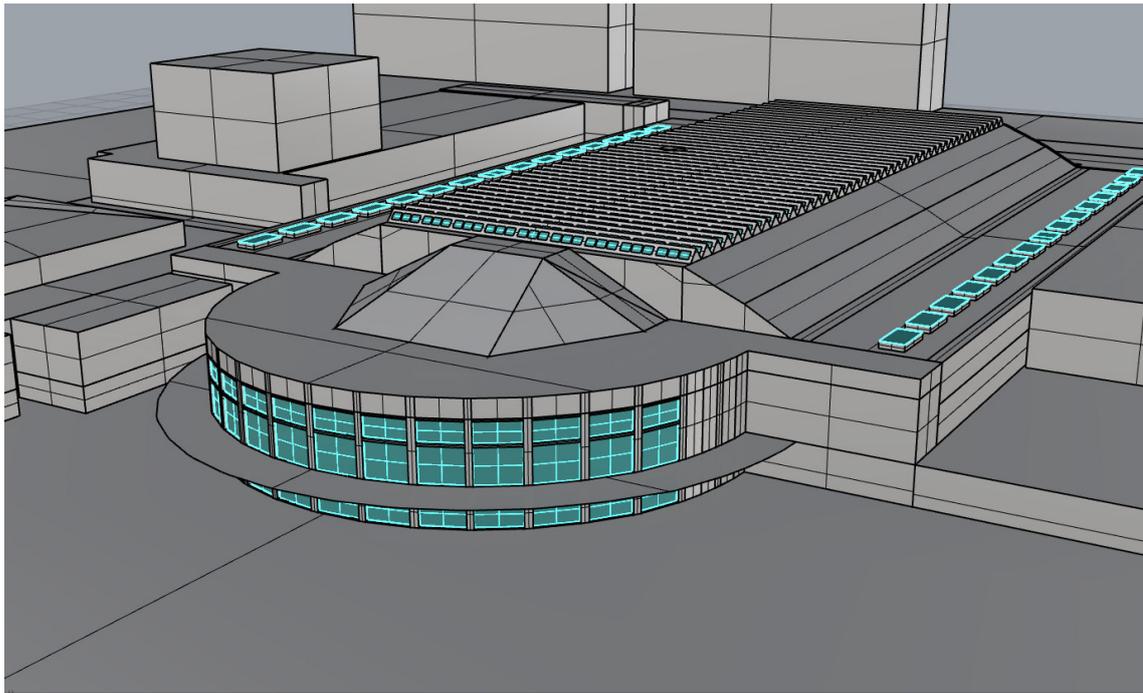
Modello 3D: vista del prospetto Sud/Sud-Est
